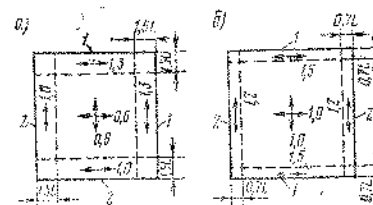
Значения переходных коэффициентов для железобетонных плит сборных покрытий:
